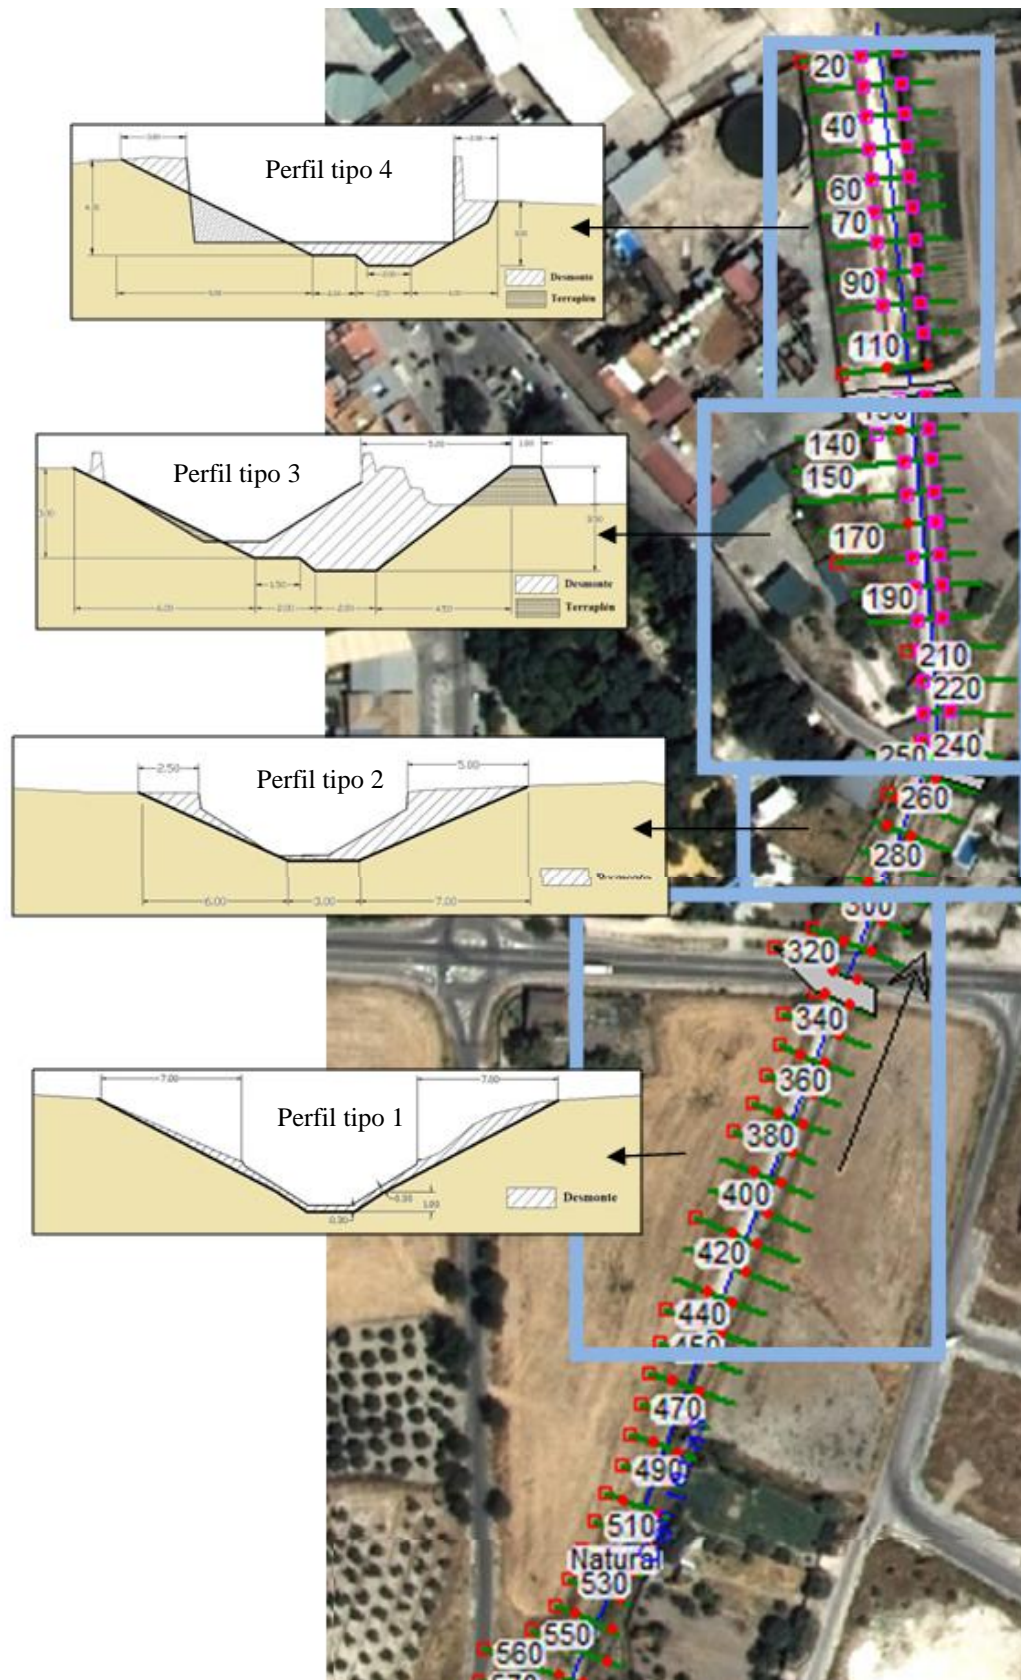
Planta con distribución de nuevos perfiles. Elaboración propia.
